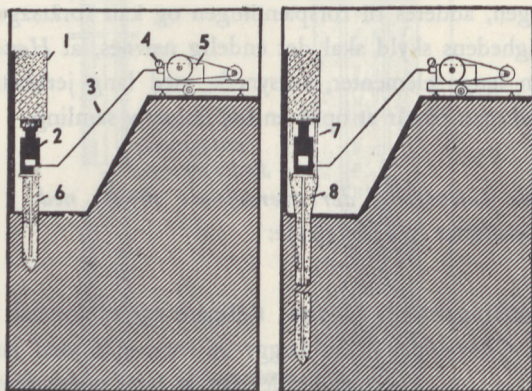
Nedpresning af Megapæle. 1: Fundament. 2: hydraulisk donkraft. 3: bøjeligt kobberbør. 4: manometer. 5: højtrykspumpe (indtil 400 atm.). 6: pælestykker. 7. profiljern. 8: topstykke.
